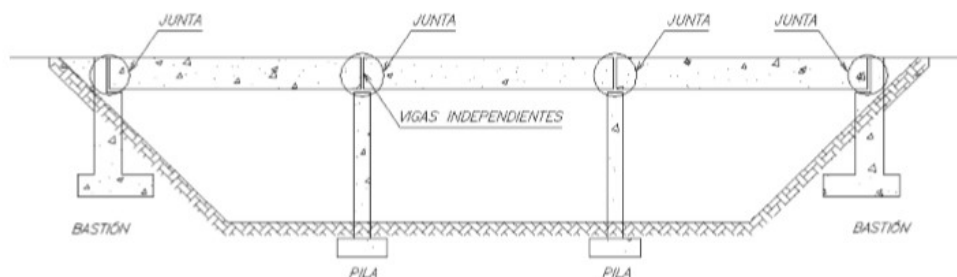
Superestructura de viga simple. Fuente: Manual de Puentes MOPT, 2007
